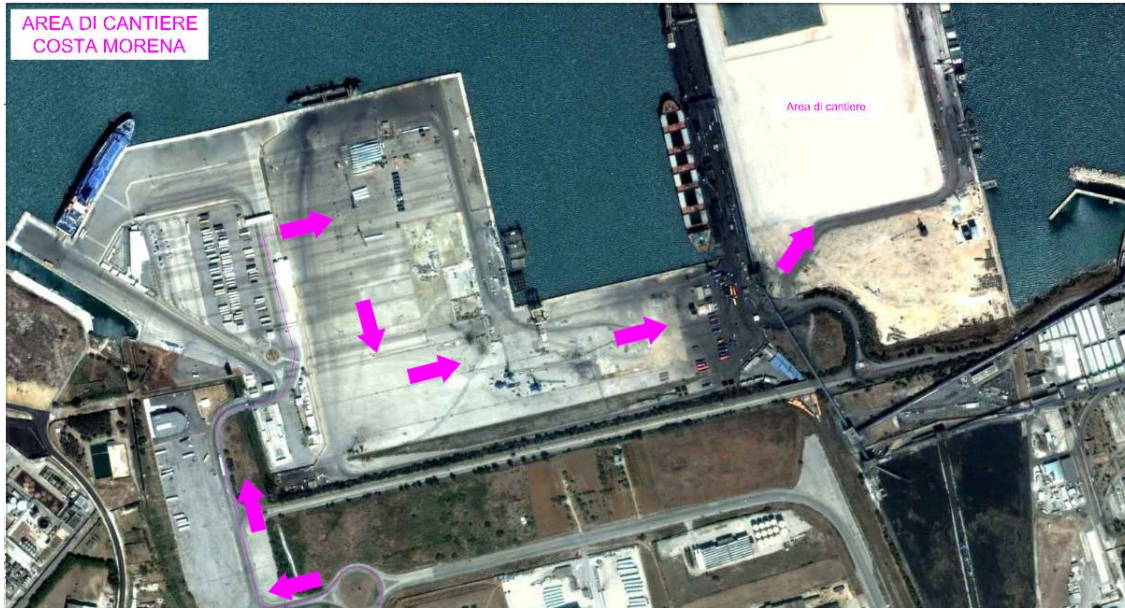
Particolare viabilità terrestre di accesso al cantiere.
